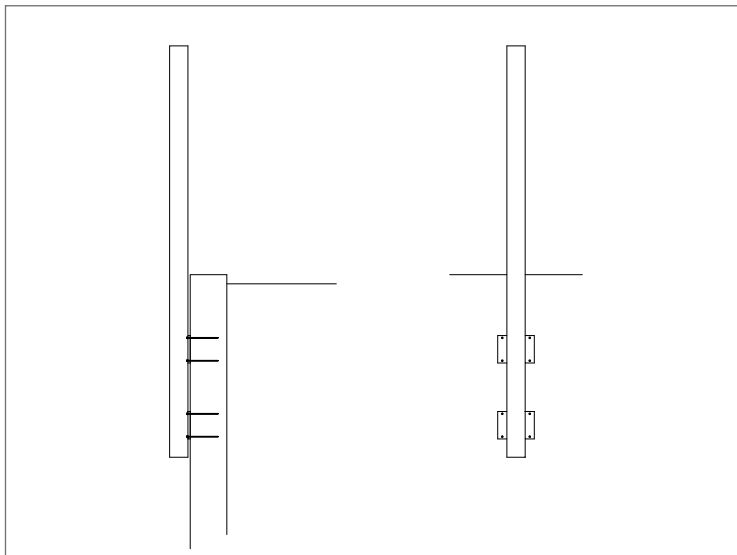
Scellement d'un poteau en parement d'un voile en béton armé
